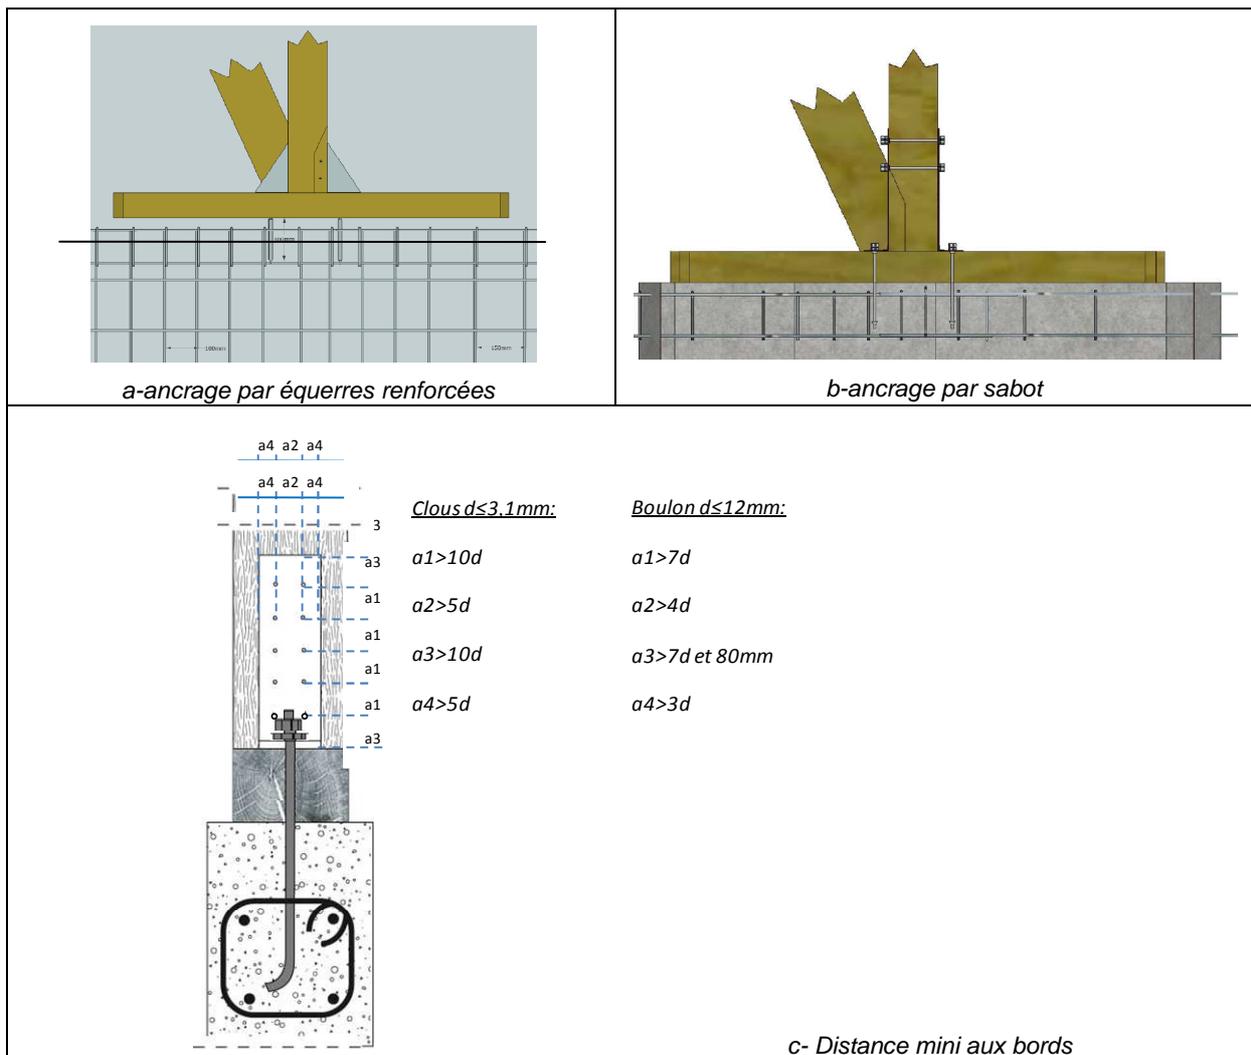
Schéma de principe d'assemblage pied de montant d'extrémité de PST par boîtier d'ancrage
